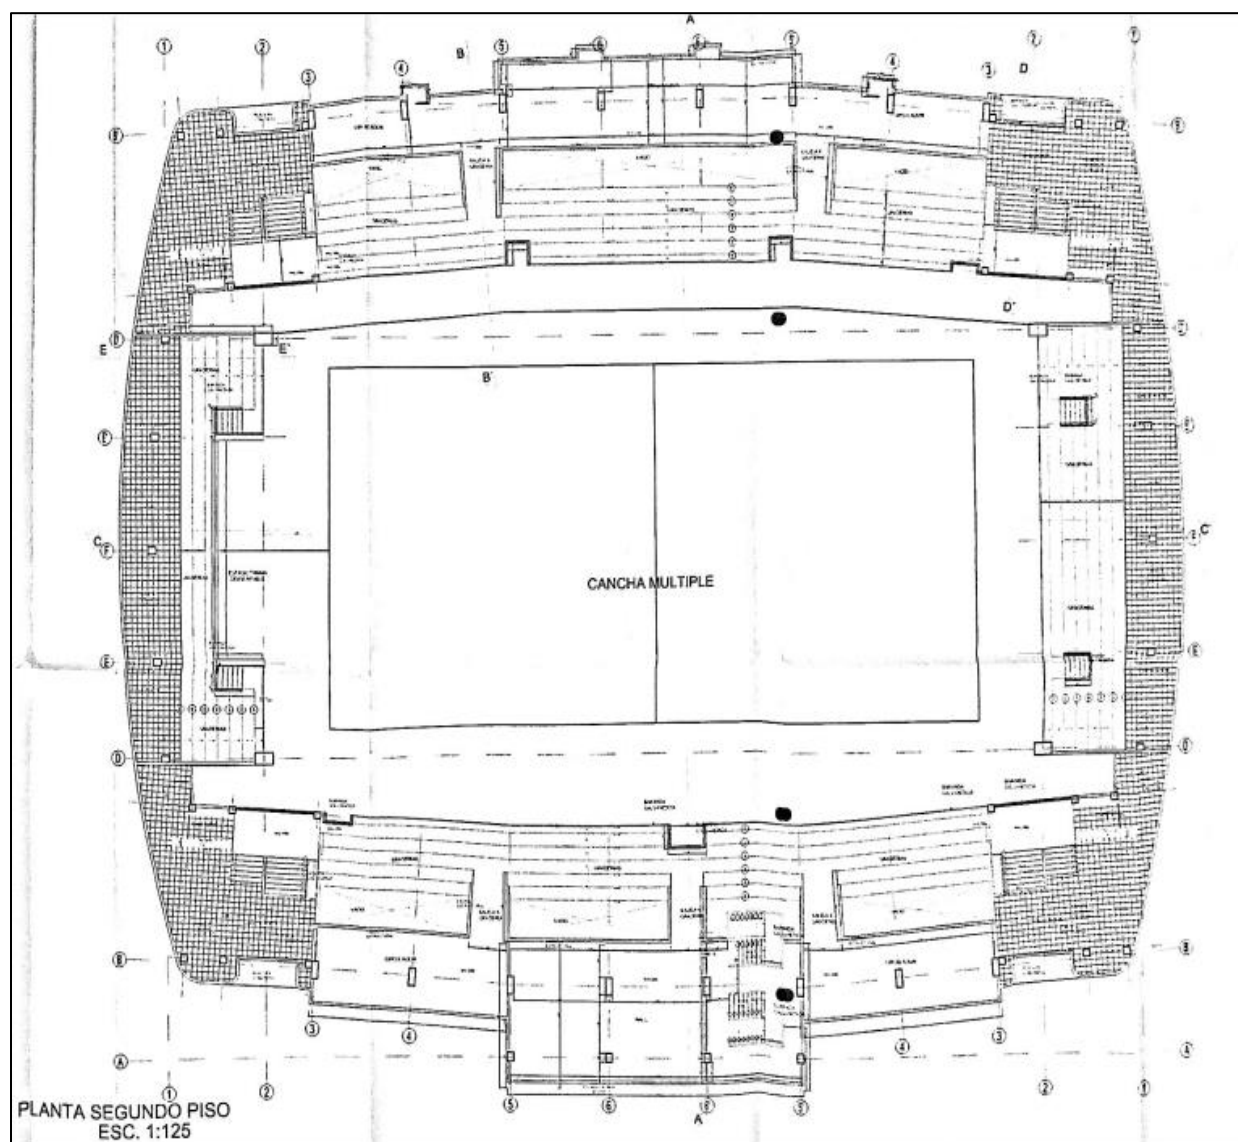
Planta General Segundo Piso Coliseo León XIII.
